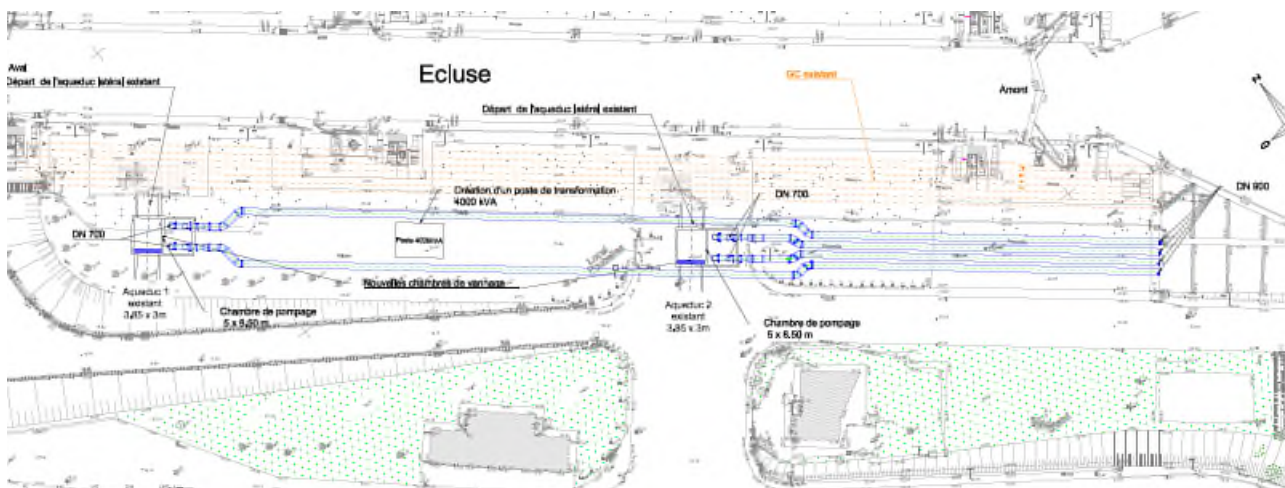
Vue n plan d'une station de pompage par pompe à hélices
